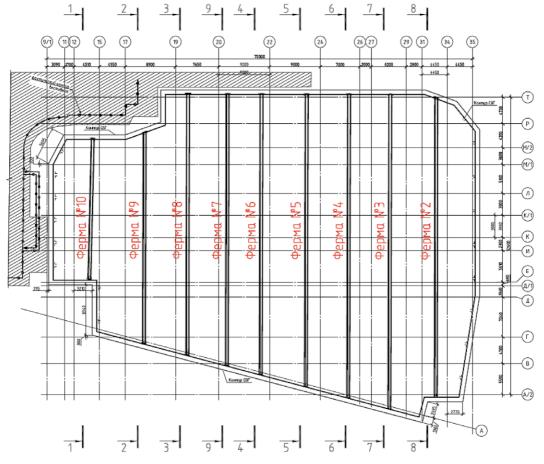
План расположения ферм распорной системы котлована Fig. 3. Layout of the trusses in the pit spacer system
